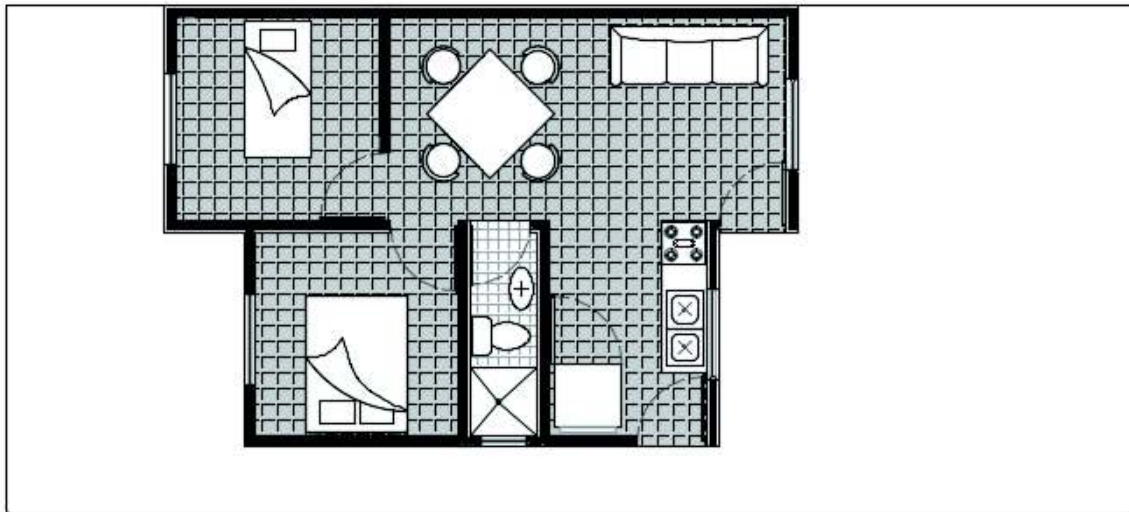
En la imagen superior se observa una planta arquitectónica que corresponde la vivienda tipo encontrada en el fraccionamiento. Es importante mencionar que esta planta arquitectónica fue producto de la observación de las viviendas ya que no se encontró información sobre la misma.
